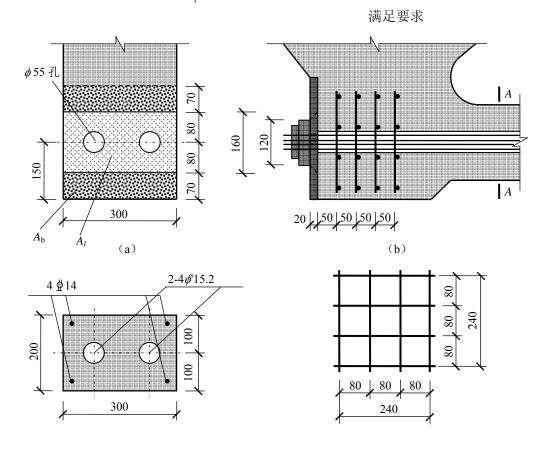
【例10-1】图 (a) 受压面积图; (b) 下弦节点; (c) *A-A*断面配筋; (d) 钢筋网片
